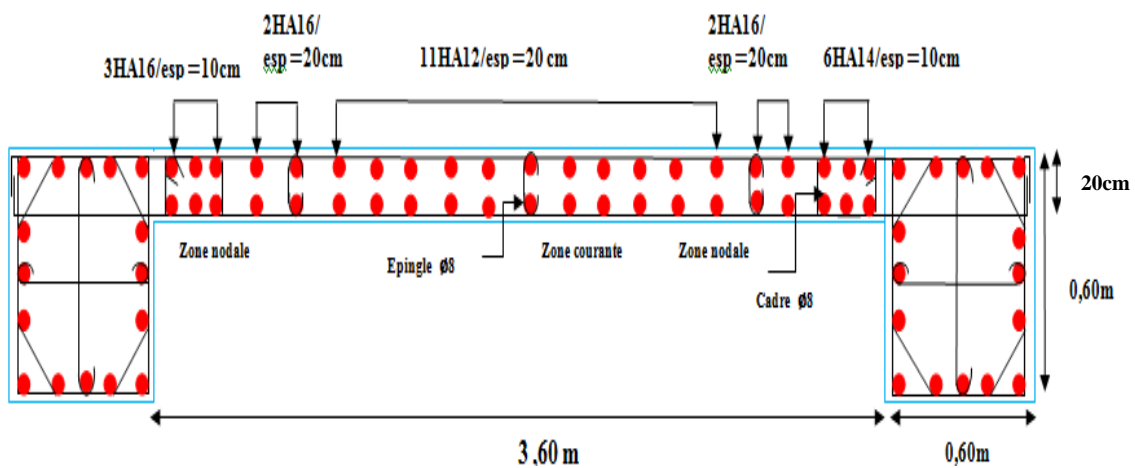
Ferrailage des voiles VY3 ;VY4.
